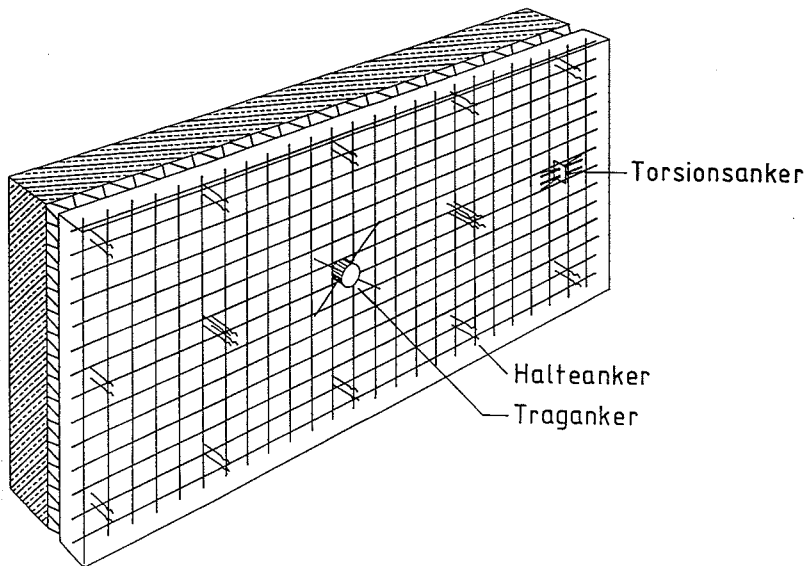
Betonsandwichtafel mit starrem Traganker im Flächenschwerpunkt
